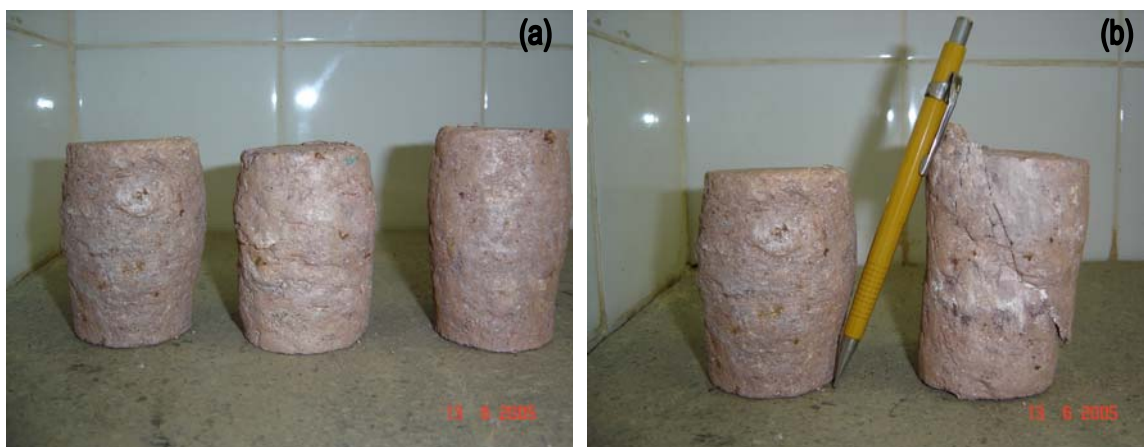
Corpos de prova após ensaio, secos em estufa.
